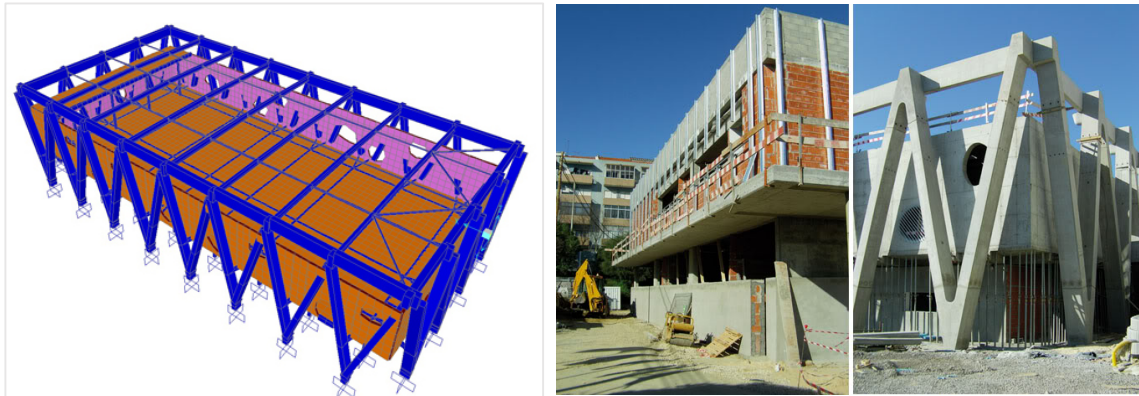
Projeto de reconstrução do pavilhão gimnodesportivo. Autor desconhecido
